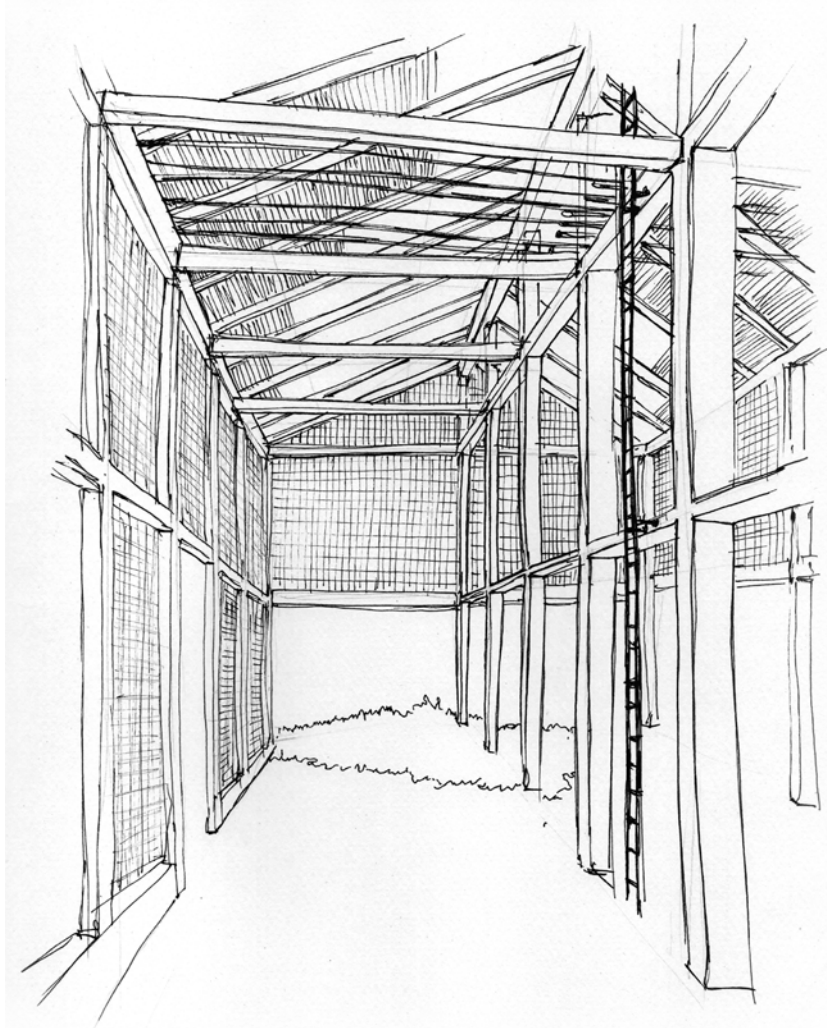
Secadero de piel de celosía prefabricada de hormigón. En este tipo de secaderos, la estructura de los pórticos es de hormigón y la de la cubierta de viguetas de hormigón prefabricado.
